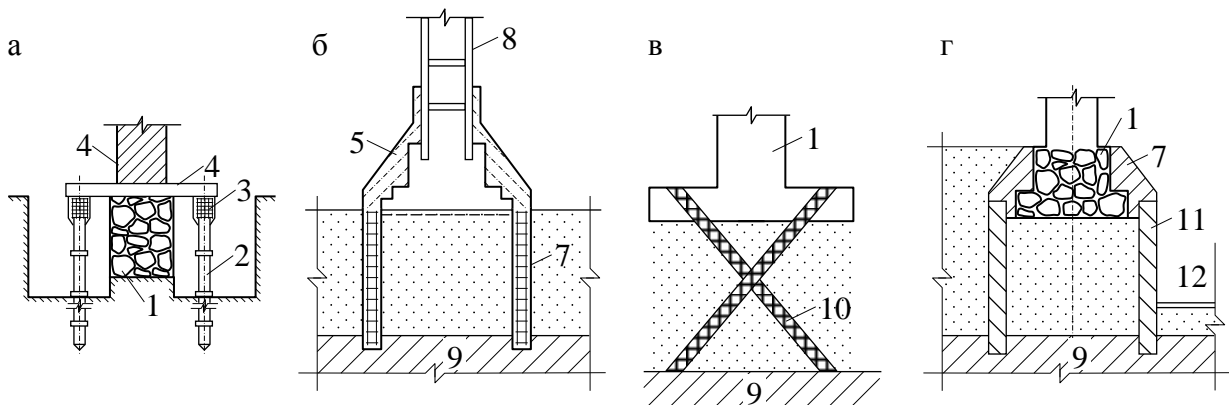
Схеми підсилення фундаментів палями та глибокими стінами: а – задавленими; б – набивними; в – буроін'єкційними; г – стіною в ґрунті; 1 – існуючий фундамент; 2 – металічні трубчаті палі; 3 – оголовок; 4 – монолітна залізобетонна балка; 5 – стіна будівлі; 6 – набивна палля; 7 – залізобетонна обойма; 8 – колона; 9 – щільний ґрунт; 10 – буроін'єкційна палля; 11 – стіна в ґрунті; 12 – підвальне приміщення
